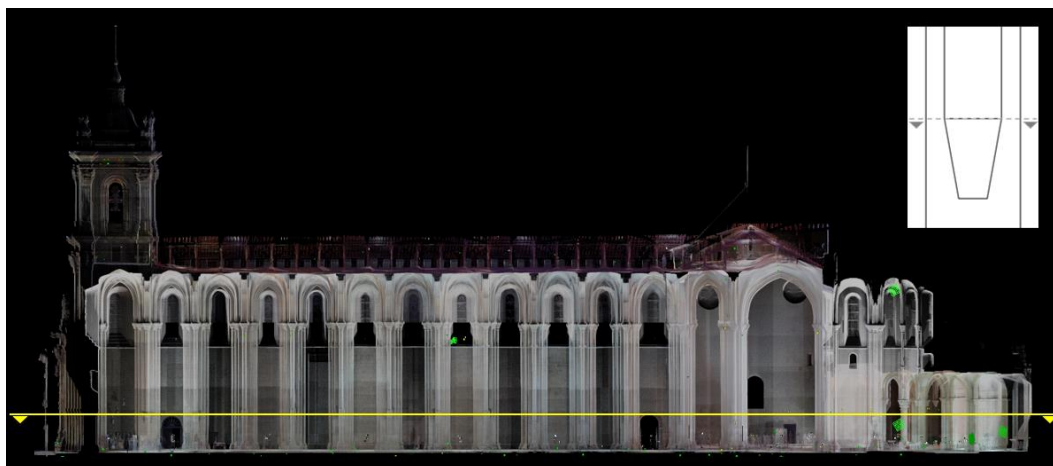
Demonstração do corte em planta pela altura das mísulas piramidais dos pilares da Igreja.
